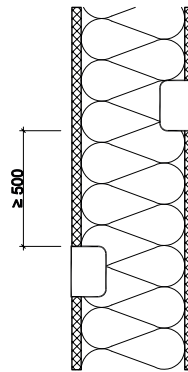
Bei Konstruktionen mit brandschutztechnisch notwendiger Dämmschicht dürfen die Einbauteile mit einem Mindestabstand von 500 mm zueinander gegenüberliegend eingebaut werden.
